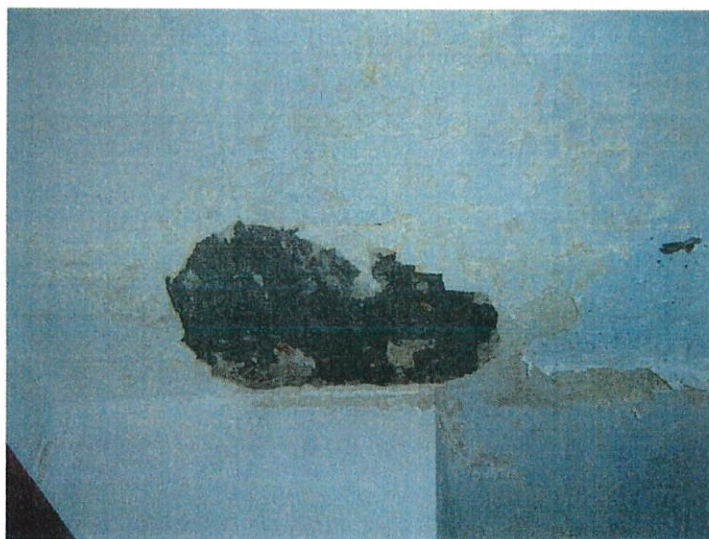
Sacristie - Infiltration d'eau à la toiture, revêtement endommagé, béton humide
